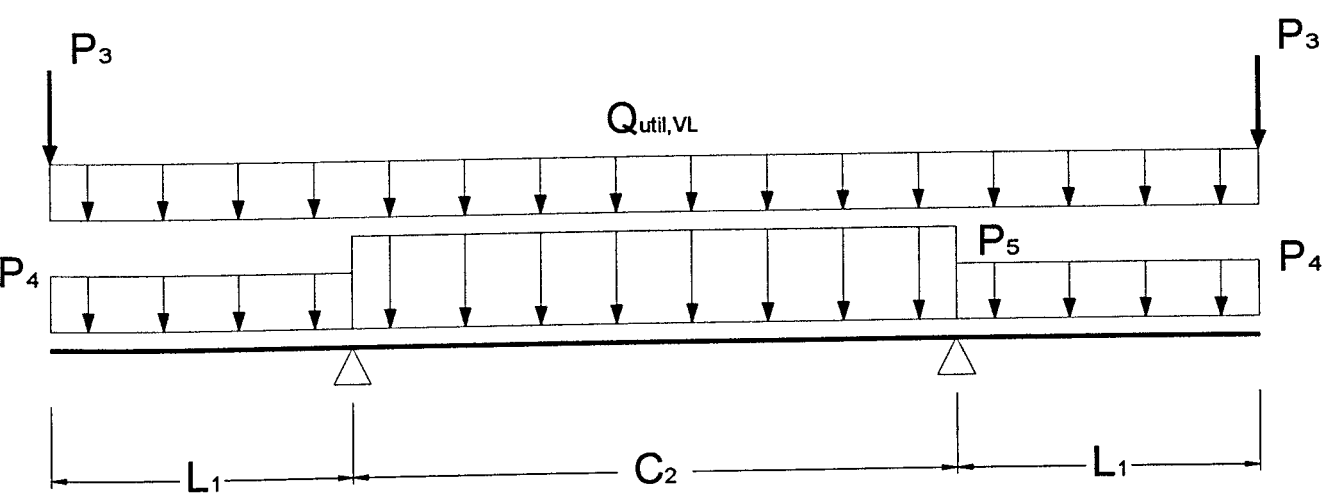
ESQUEMA ESTRUTURAL SIMPLIFICADO DA VIGA LANÇO
